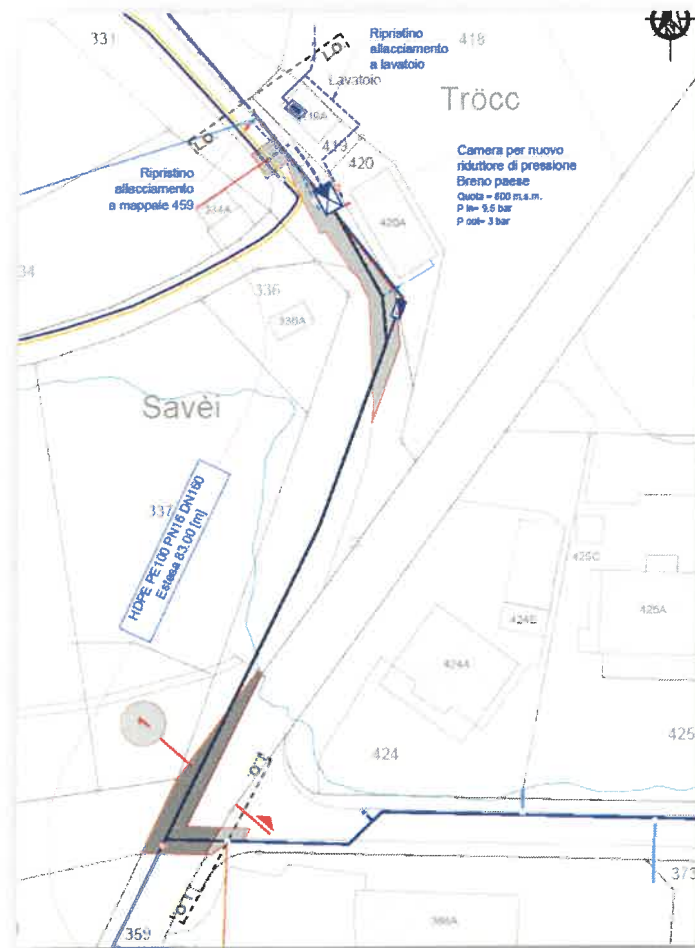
Stralcio planimetrico con individuata la nuova condotta di allacciamento alla rete di Breno
